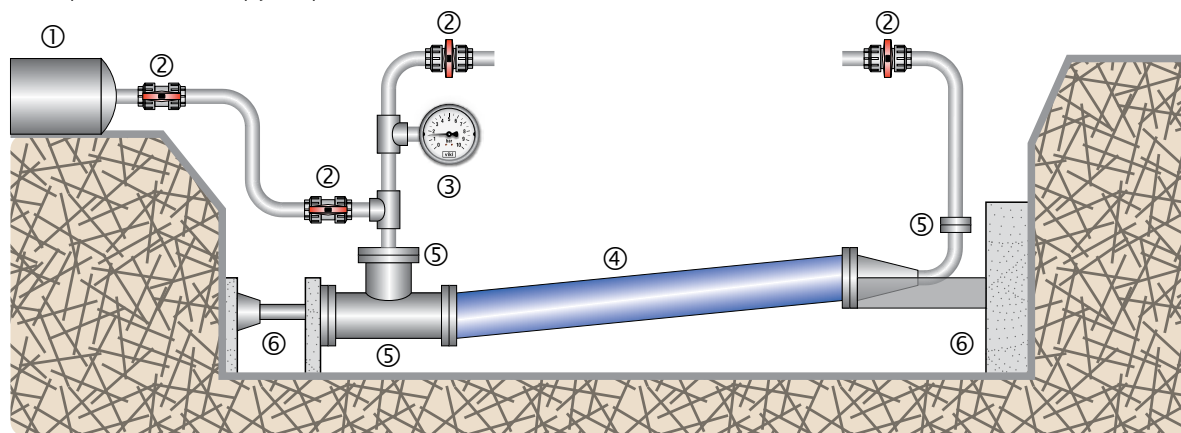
Принципиальная схема гидравлических испытаний подземного трубопровода
